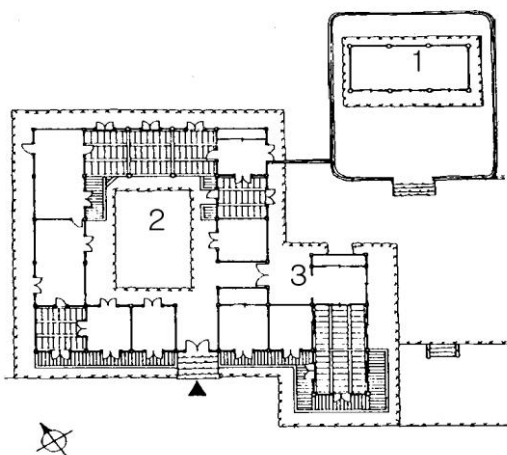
Grundriss der koreanischen traditionellen Wohnung
